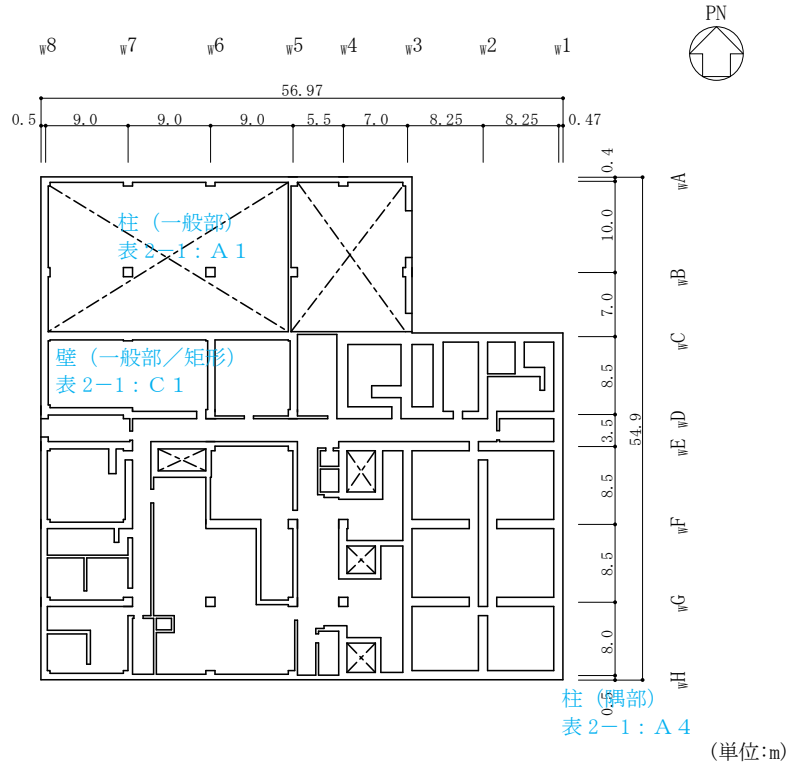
(6) 廃棄物処理建物の概略平面図 (EL 26.7m)
